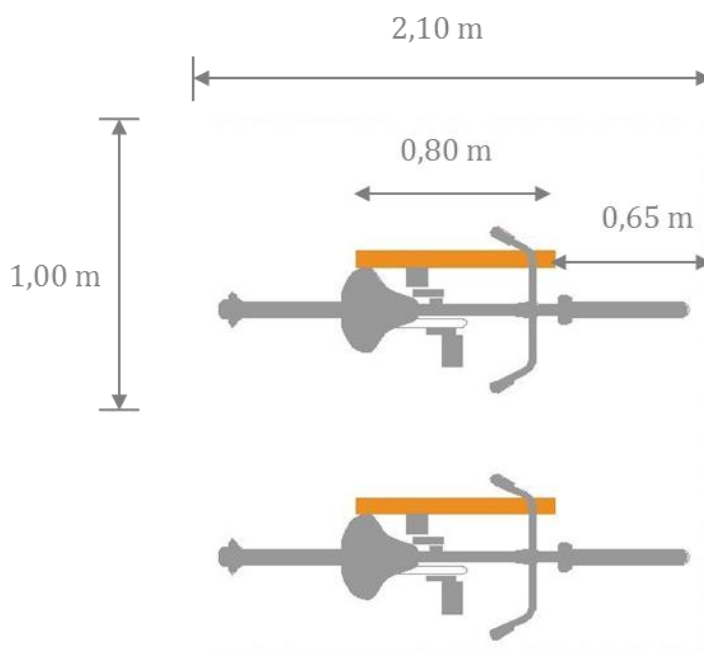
Detalhe do modelo de suporte inglês Sheffield em planta
